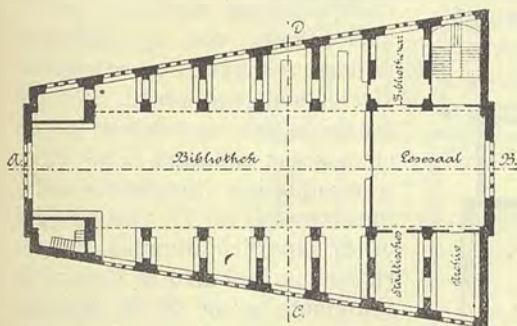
a, b, c. — Biblioteca di Schlettstadt (arch. J. J. Stamm).
